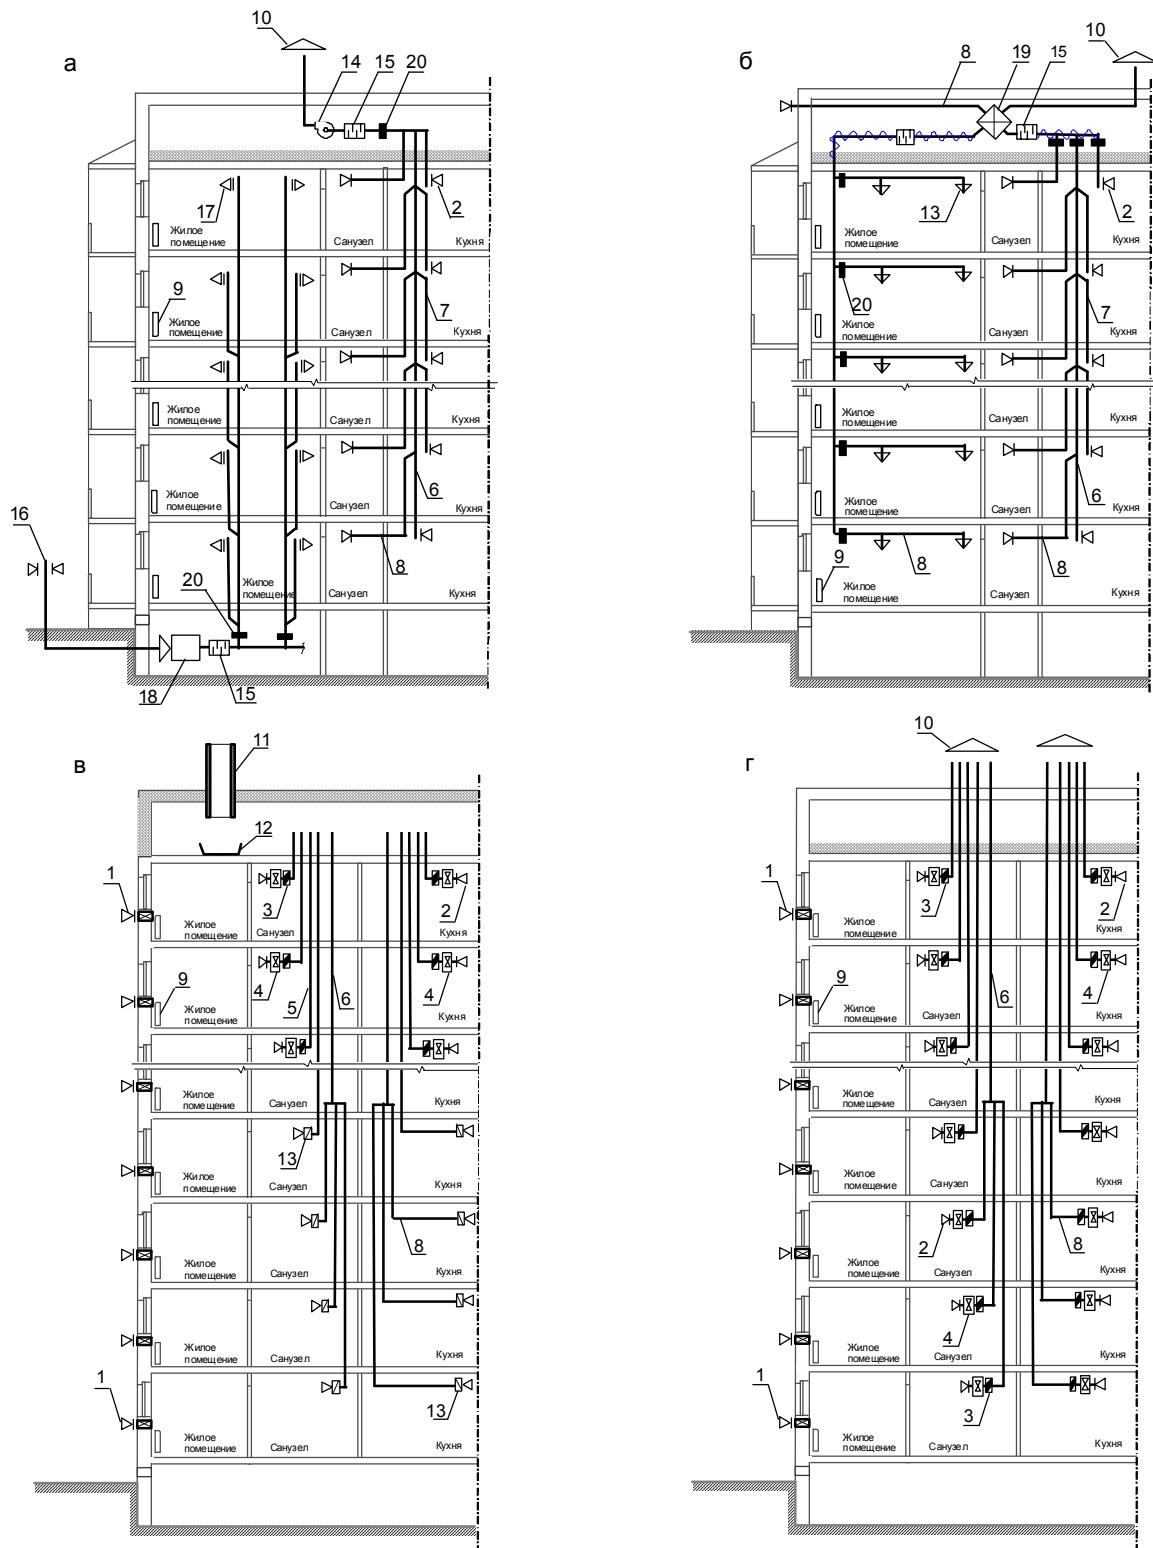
Схемы систем вентиляции с механическим притоком и удалением воздуха (а, б), зданий повышенной этажности (в, г): 1 – приточное вентиляционное устройство; 2 – вытяжная вентиляционная решетка; 3 – обратный клапан; 4 – вытяжной вентилятор с регулируемым количеством оборотов; 5 – вертикальный вентиляционный канал; 6 – сборный вентиляционный канал; 7 – канал-спутник; 8 – горизонтальный вентиляционный канал; 9 – прибор системы отопления; 10 – зонт; 11 – вытяжная вентиляционная шахта; 12 – поддон; 13 – вытяжной вентиляционный клапан; 14 – радиальный вентилятор; 15 – шумоглушитель; 16 – воздухозаборная шахта; 17 – приточная вентиляционная решетка; 18 – приточная вентиляционная установка с подогревом воздуха; 19 – приточно-вытяжная установка с рекуператором; 20 – огнезащитный клапан
